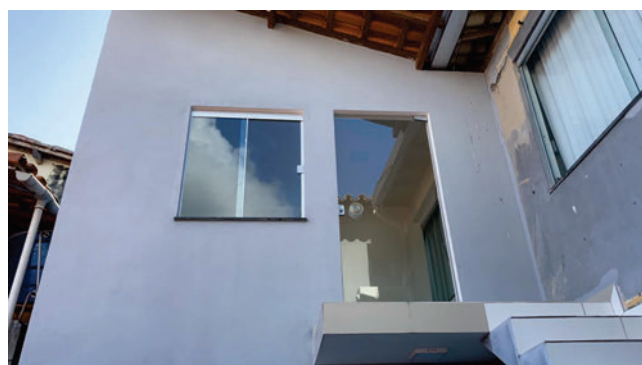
Vista Parcial do Prédio Anexo (térreo e pavimento superior)
